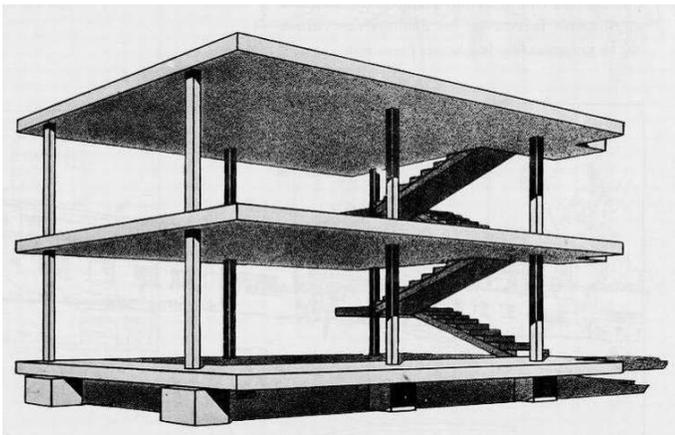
Sistema Dom-ino (imagen de Archdailys, 2014)
